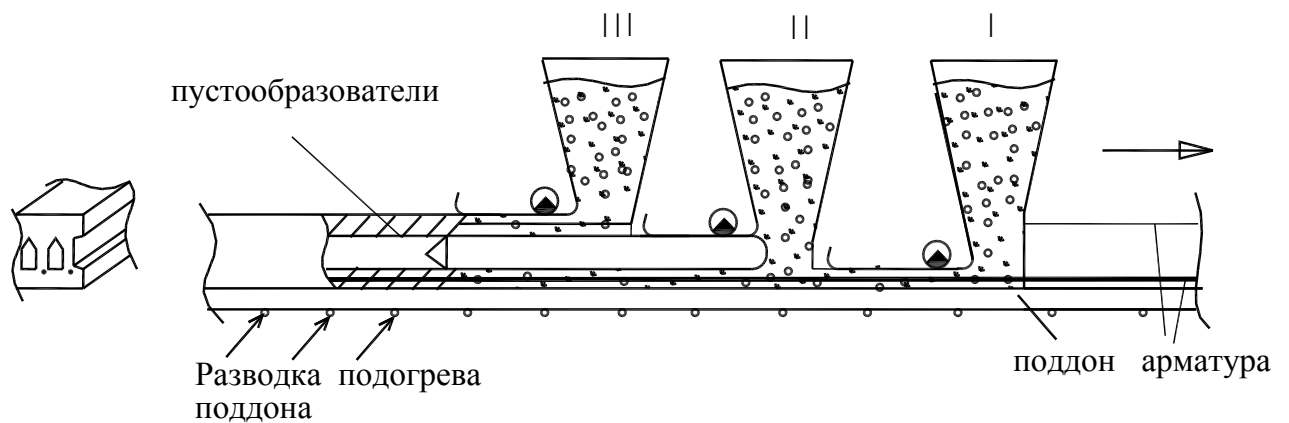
Принципиальная схема безопалубочного формования изделий с 3-слойной укладкой бетона.
